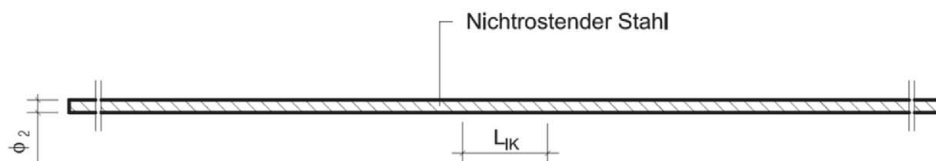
Druckelement aus nichtrostendem Betonstahl
